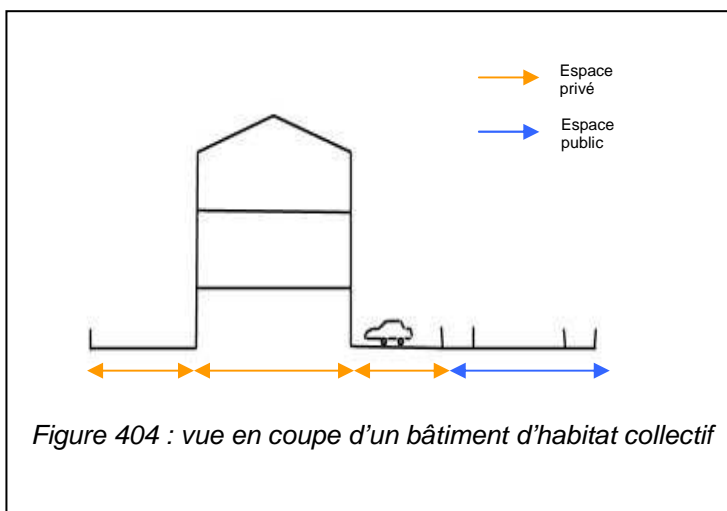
vue en coupe d'un bâtiment d'habitat collectif
